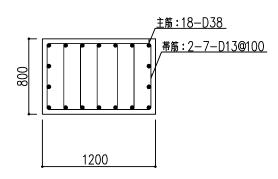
柱の配筋図(地下2階, X3/YF通り, 柱脚部)(単位:mm)
